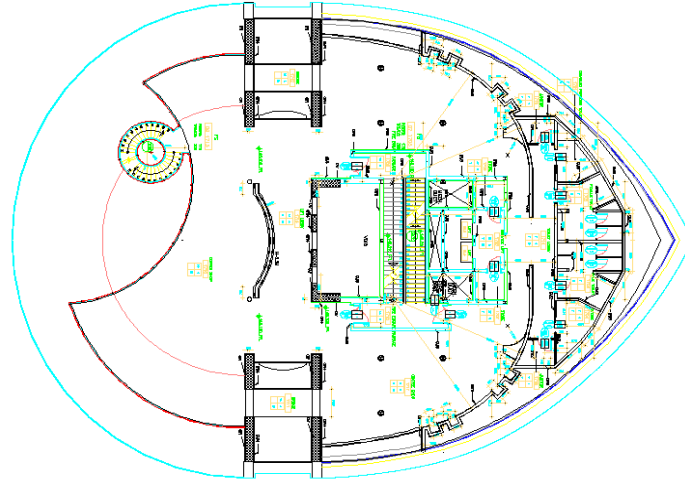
مسقط افقي للطابق الثالث
